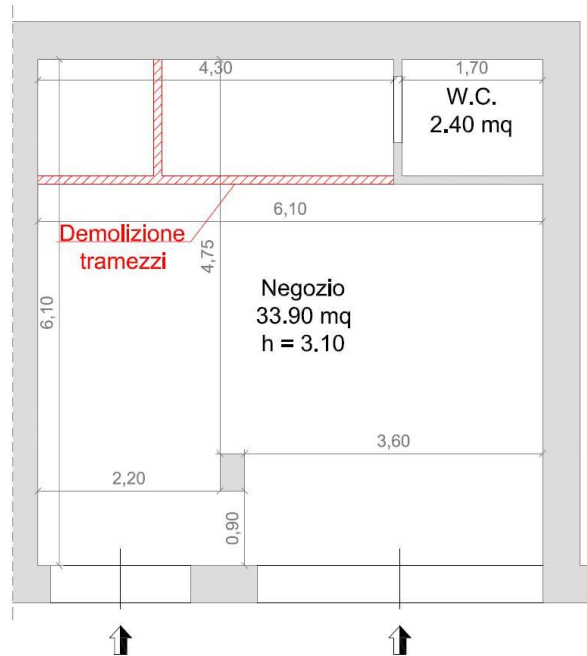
Planimetria Stato di fatto Foglio 29, p.lla 748, sub 11.
